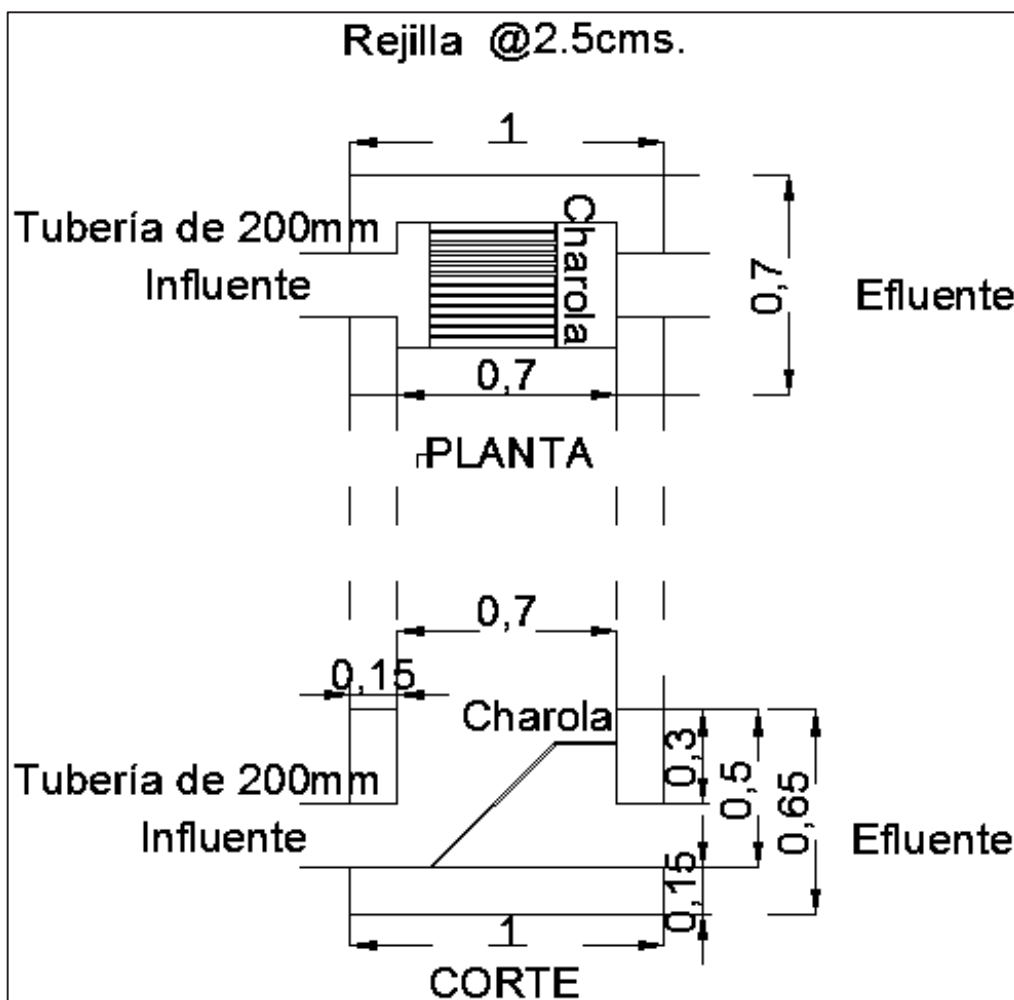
2 Vistas en planta y corte transversal de la rejilla
